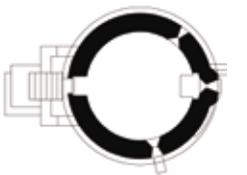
Grundriss Cordon/Wener 2010. M 1:400.
